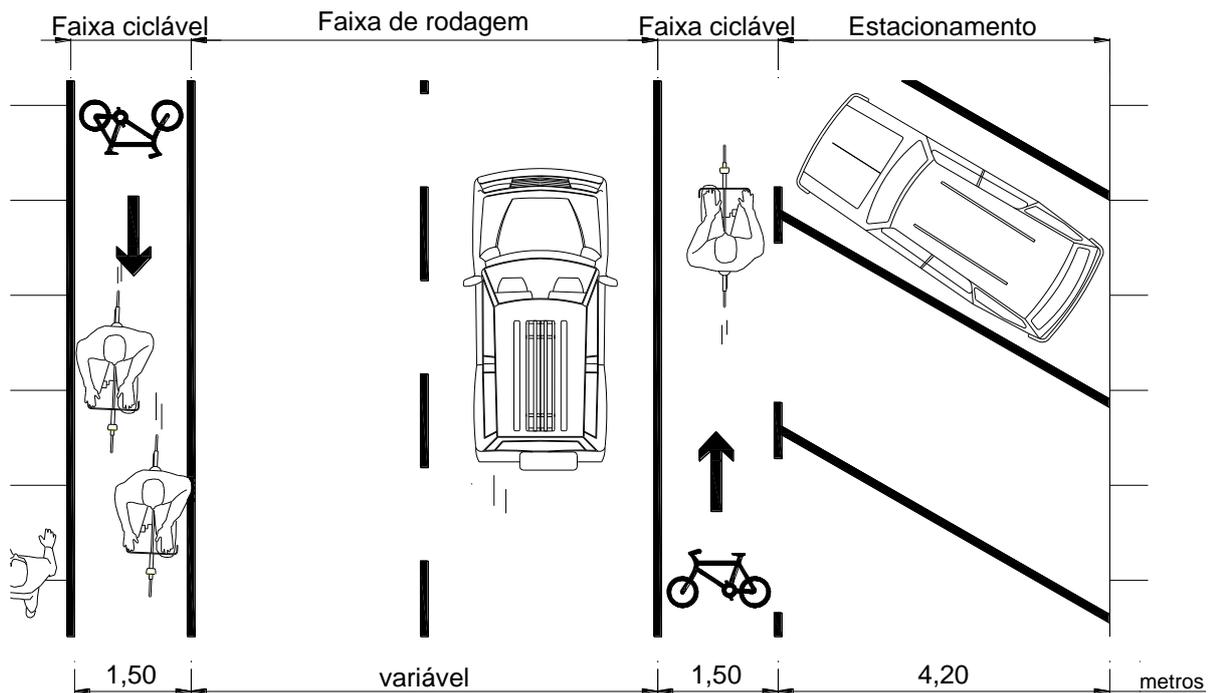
Planta tipo para a implementação de faixas cicláveis depois da zona de estacionamento (fonte própria)
